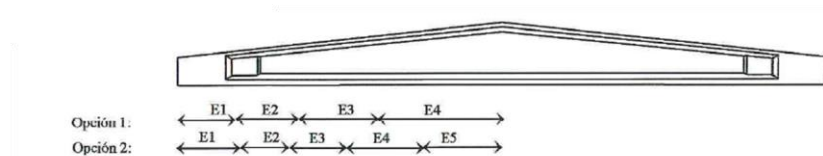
Armado Longitudinal T4 (fuente: Gilva)
